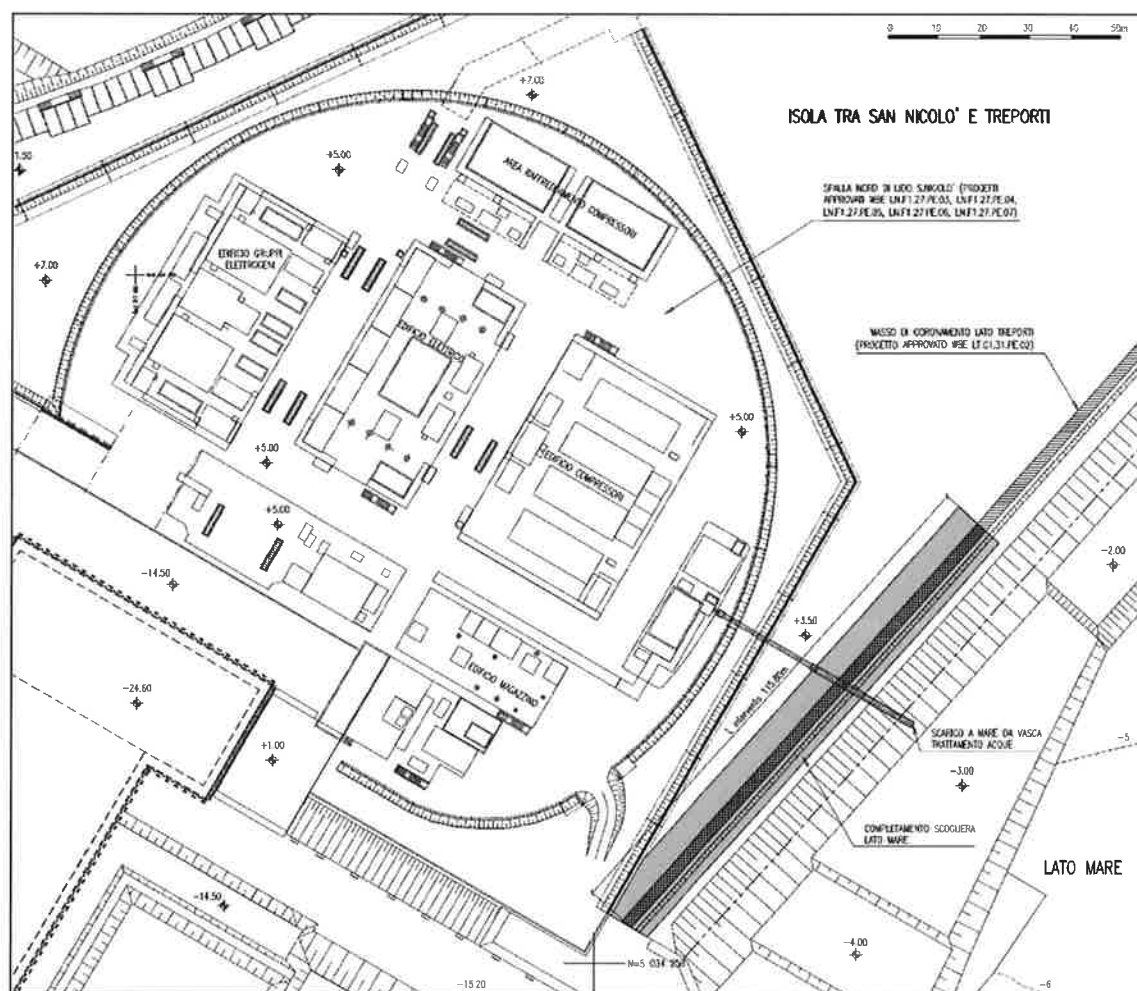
WBE-01 – PLANIMETRIA DI PROGETTO
